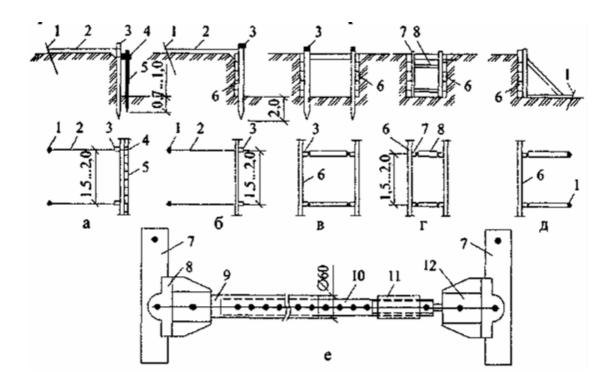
Схемы временного крепления вертикальных стенок выемок (размеры в метрах): а - шпунтовое ограждение; б - консольное; в - консольно-распорное; г - распорное (горизонтально-рамное); д - подкосное; е - инвентарная трубчатая распорная рама; 1 - анкерная свая; 2 - оттяжка; 3 - маячная свая (опорная стойка); 4 - направляющая; 5 - шпунтовое ограждение; 6 - щиты (доски); 7 - стойка распорной рамы; 8 - распорка; 9 - наружная труба; 10 - внутренняя труба; 11 - поворотная муфта; 12 - опорная часть распорки
